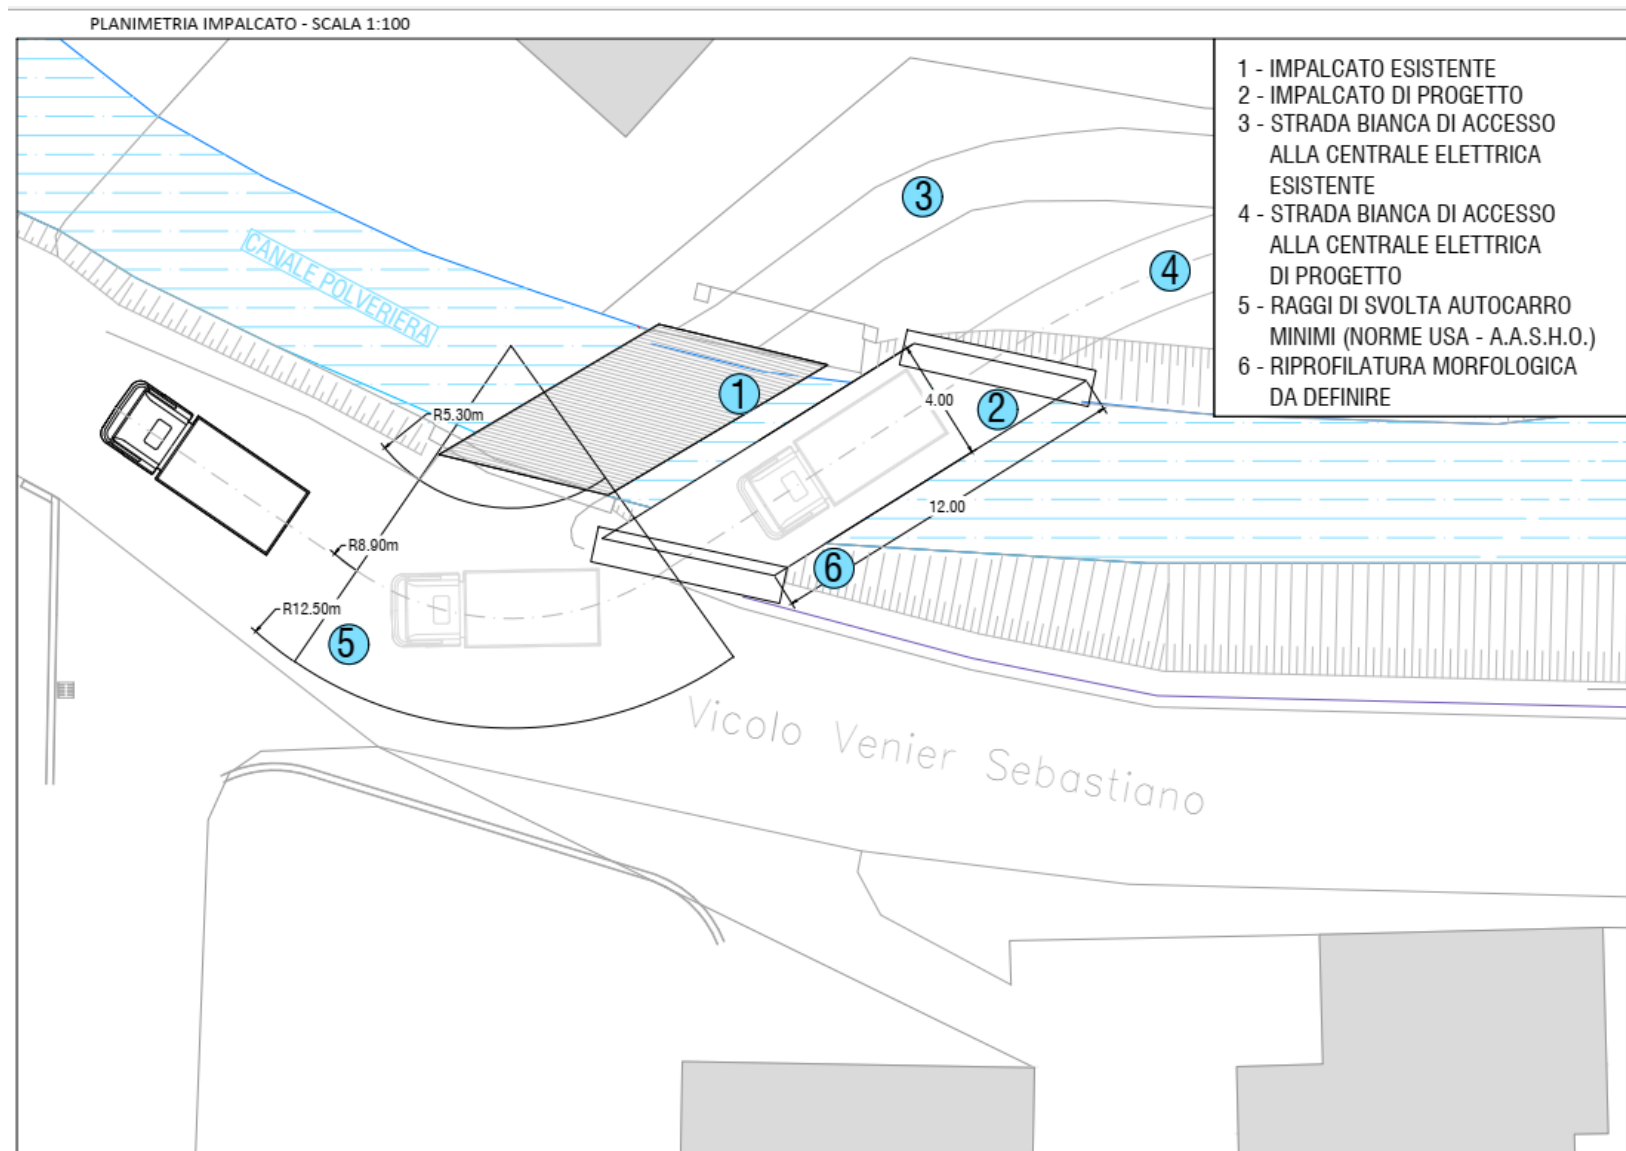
E : Inquadramento planimetrico PROGETTO CANALE DELLE POLVERIERA LUNGO VICOLO VENIER SEBASTIANO
